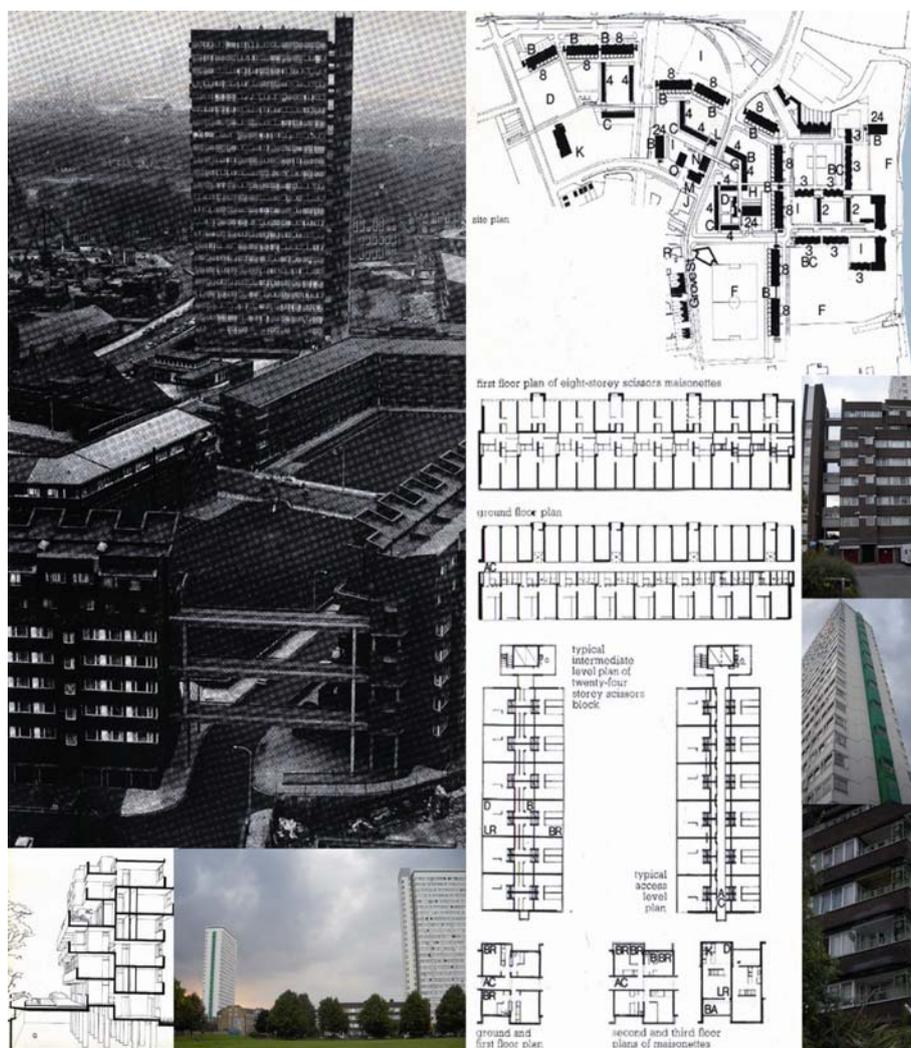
Pepys Estate*. L'immagine in alto a sinistra, la planimetria generale, le piante tipo e la sezione sono tratti dalla rivista *Architectural Review*, n.883, settembre 1970, pag. 156. Le foto piccole riproducono il Quartiere allo stato attuale e sono state scattate nell'agosto 2009, durante un periodo di ricerca e studio.
